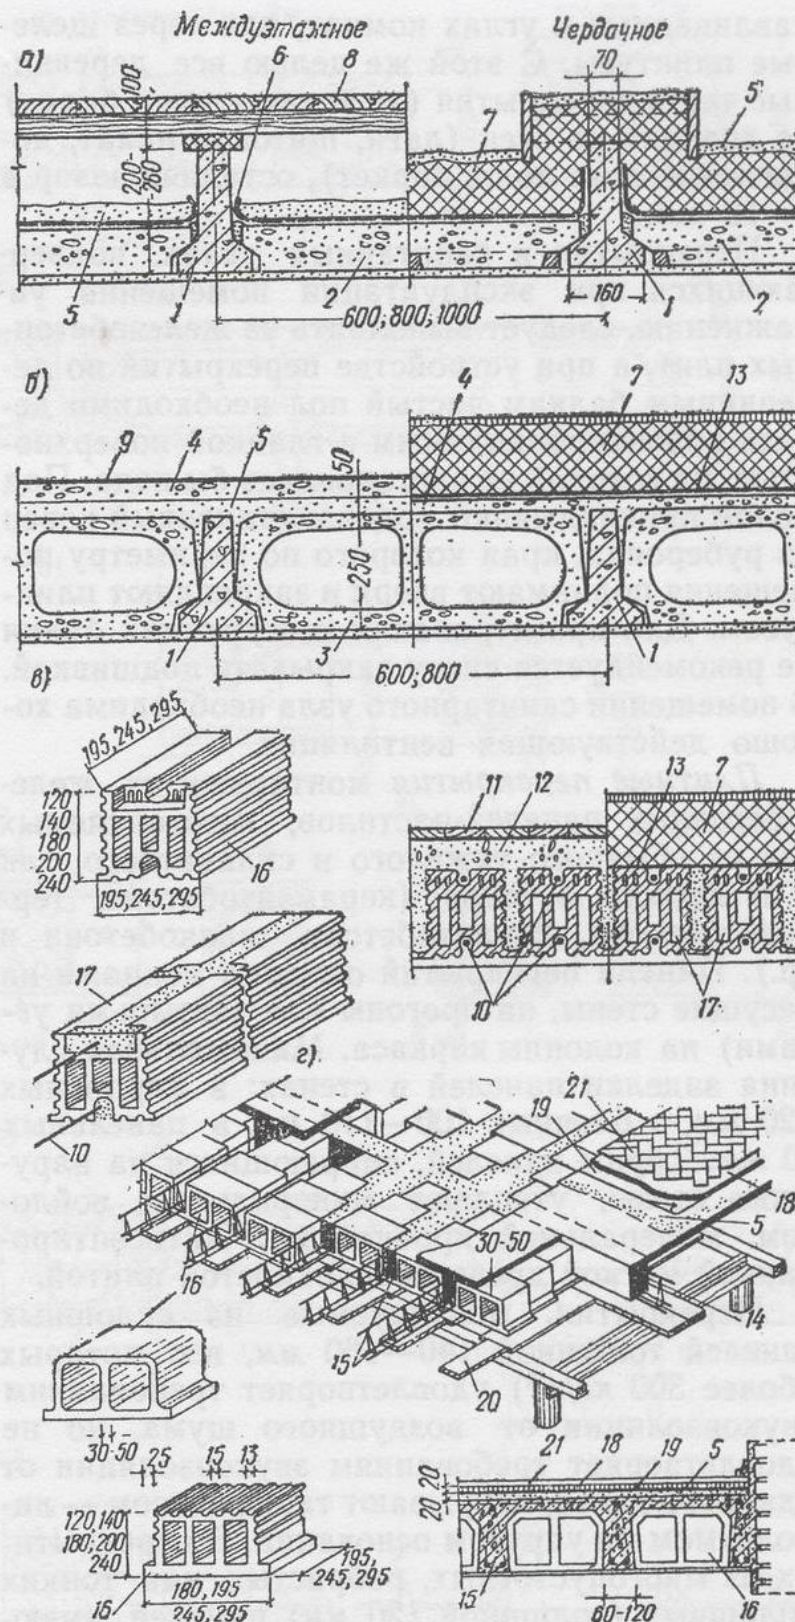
Перекрытия по железобетонным и керамическим балкам
